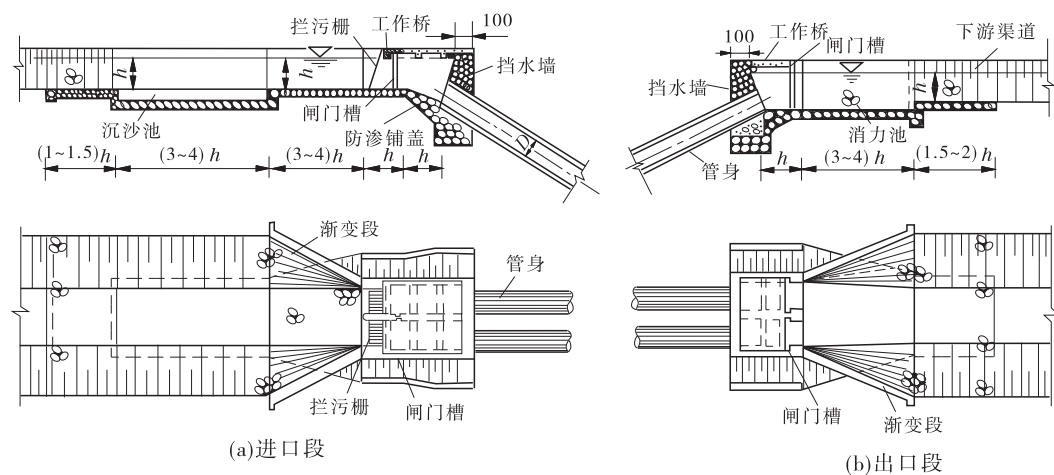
双管倒虹吸进出口段布置与构造 (单位:cm)
